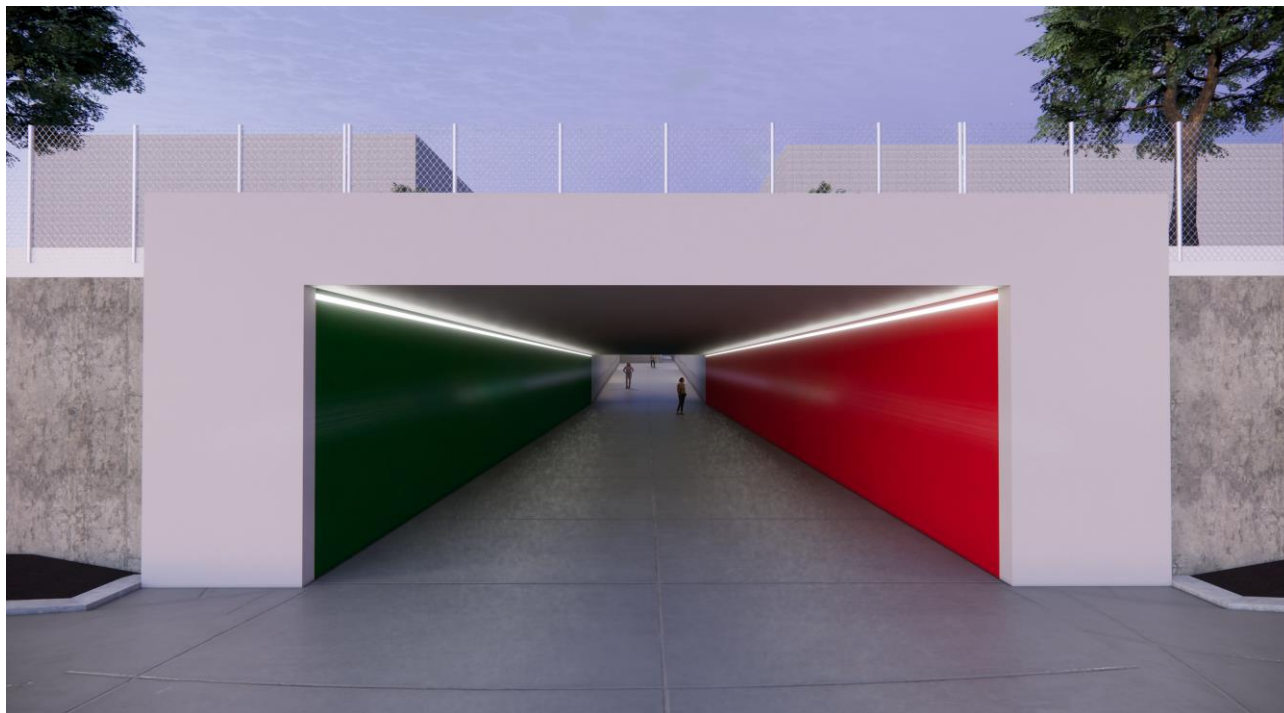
Vista prospettica portale di accesso lato Stadio.
